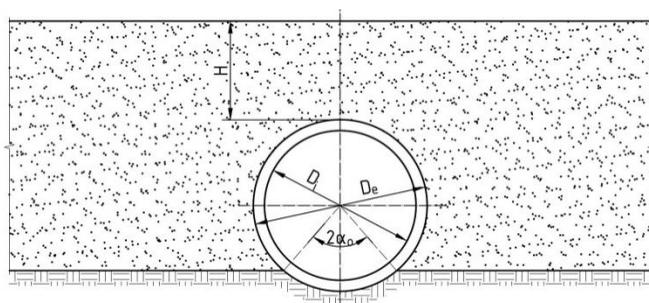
Укладка труб в насыпь на грунтовое профилированное основание
